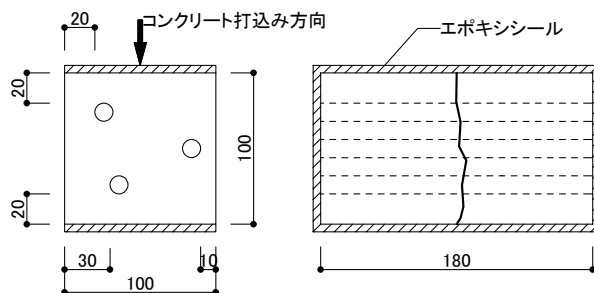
貫通ひび割れ試験体(試験体タイプ A)
